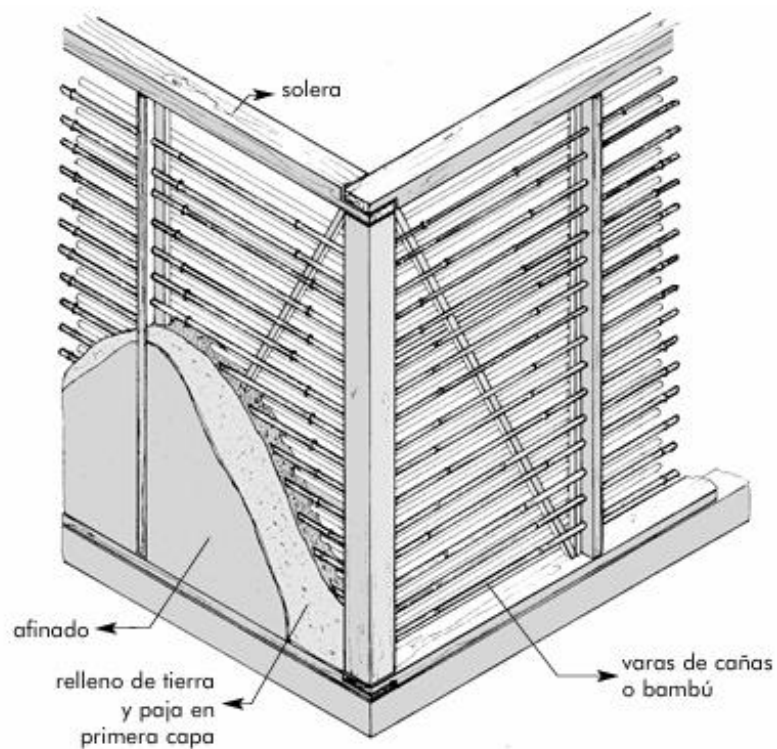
Detalle de la estructura del muro en bahareque tradicional
